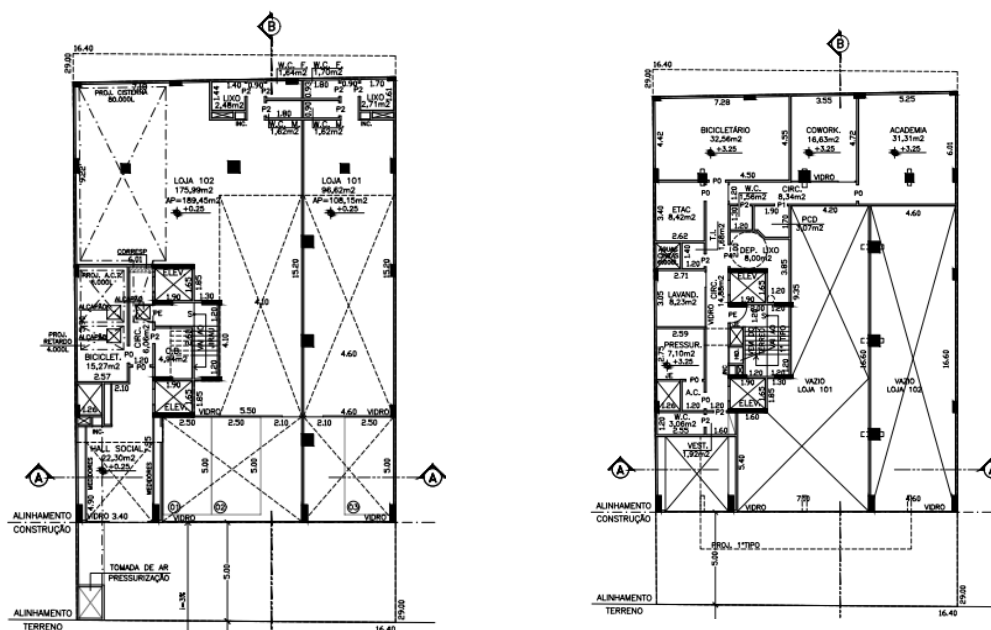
Térreo e Jirau - Fonte: Projeto Legal
